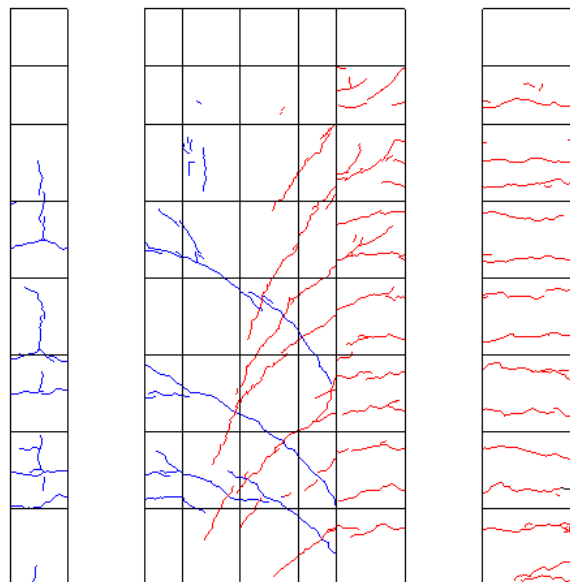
R=-1/200②ひび割れ図
